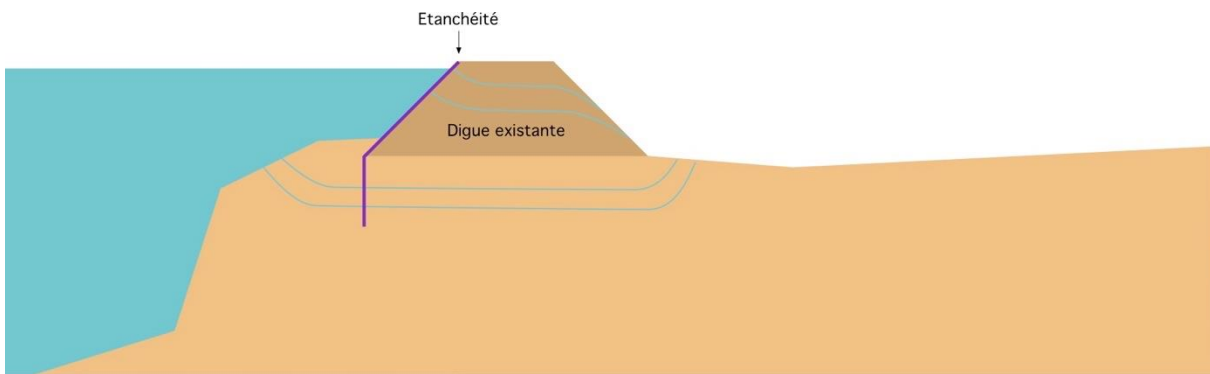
Étanchéité par masque amont pour la digue et la fondation.
